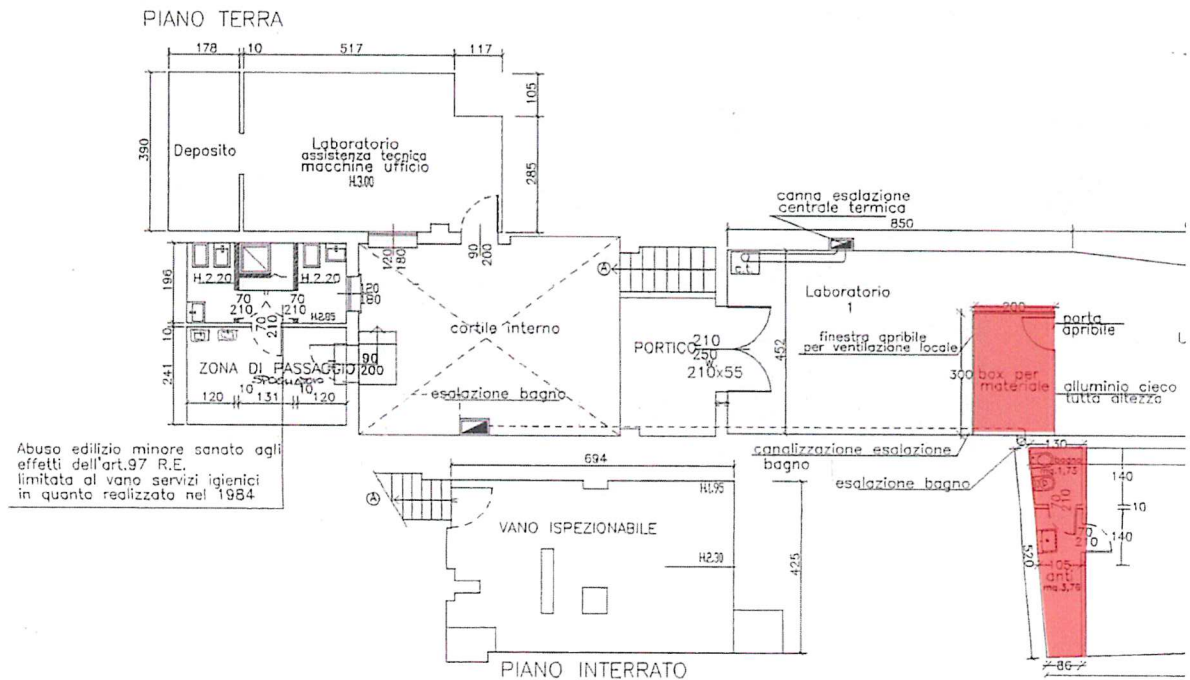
Progetto di sistemazione interna, 1998 – STATO LEGITTIMO
